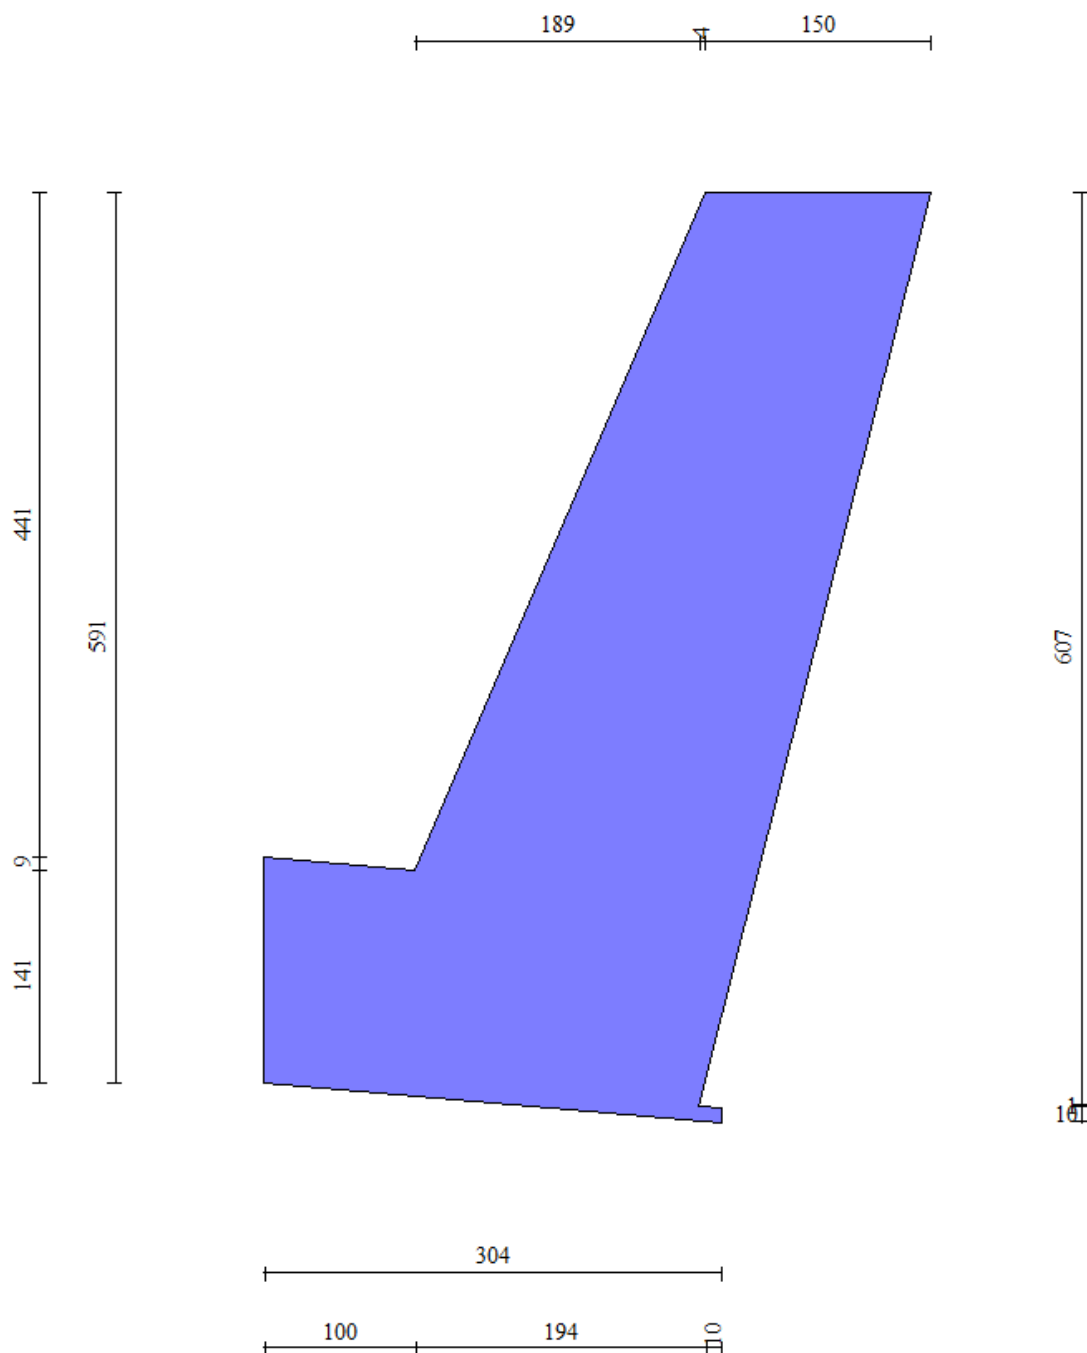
Estratto dal software di calcolo MAX 16.0 – Geometria di modellazione in sezione
